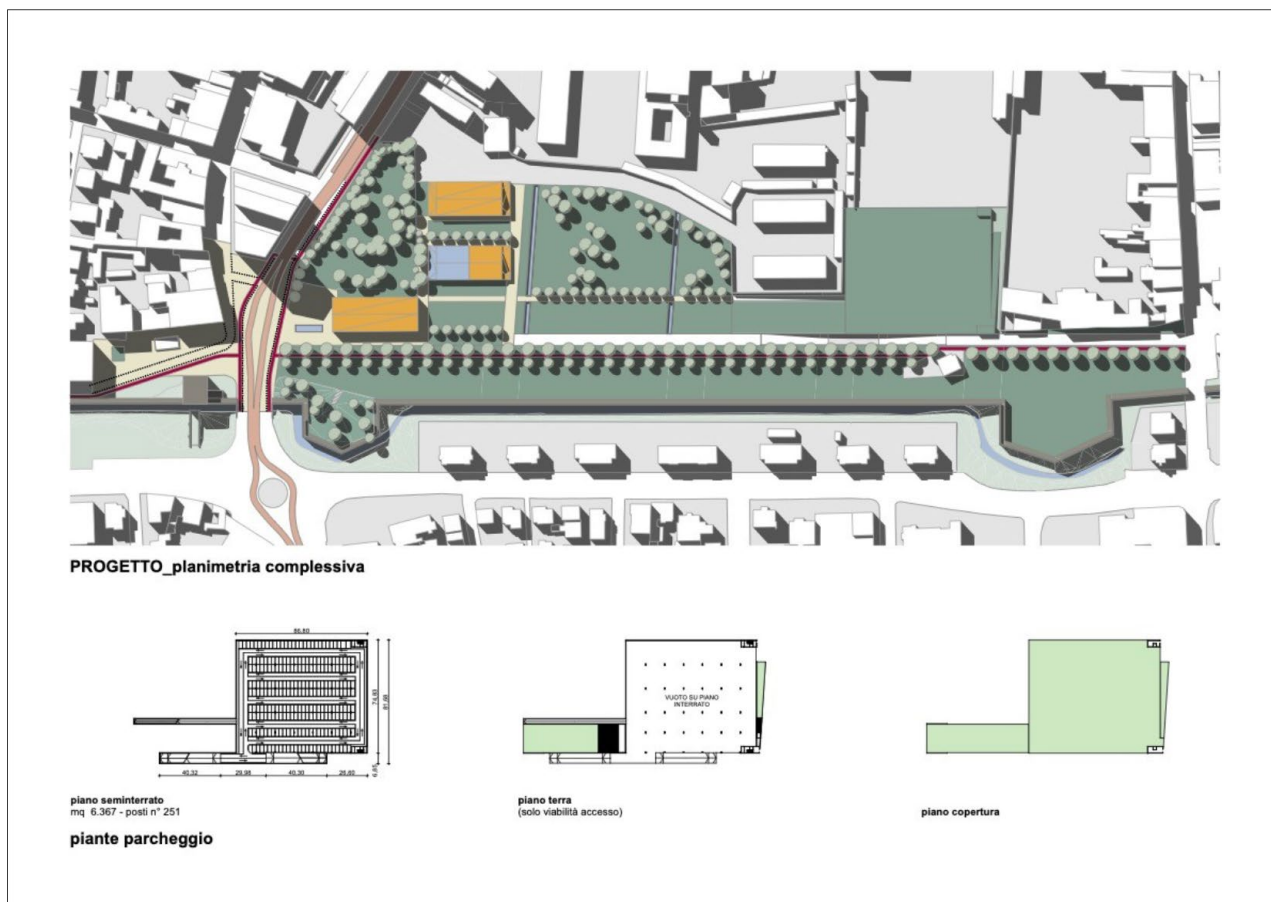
Alternativa 02 con parcheggio seminterrato (250 stalli) (fonte DOCFAP).
